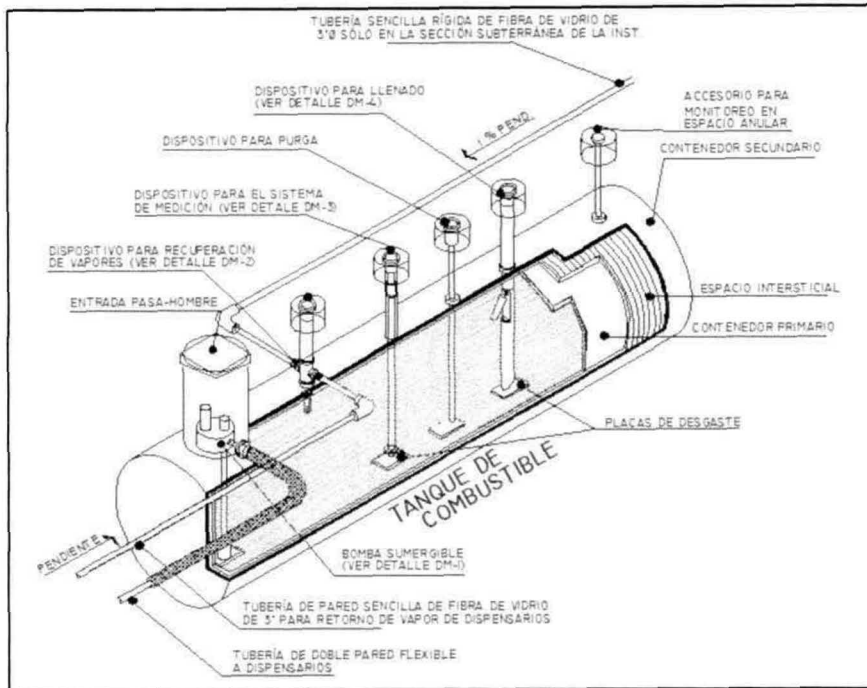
Detalles de Instalaciones en el tanque de almacenamiento.
